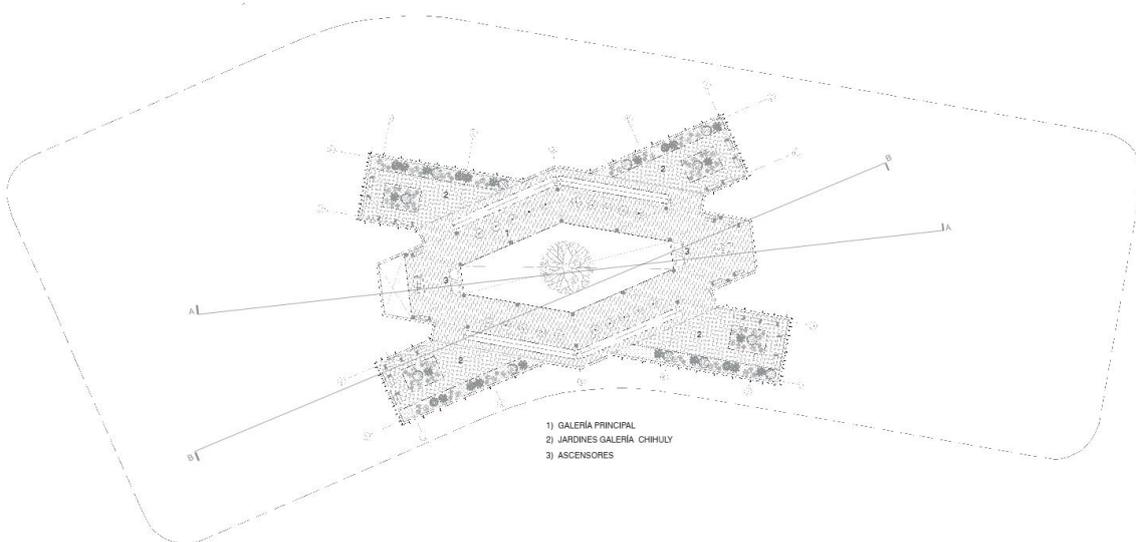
Planta PB + 10.50m. Elaboración propia
